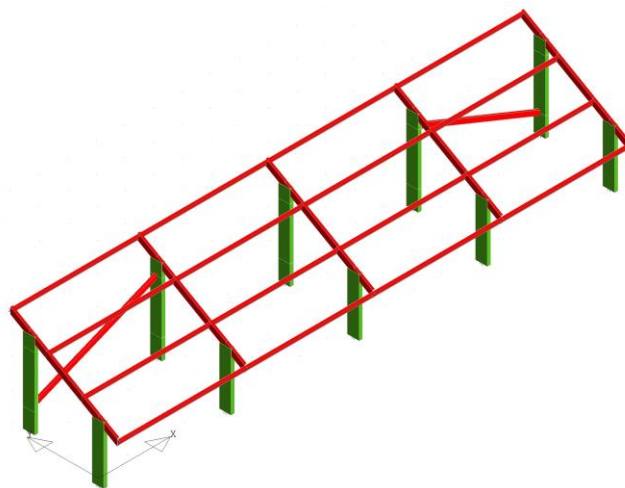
Vista assometrica telaio fisso in aree ad attività zootecnica
